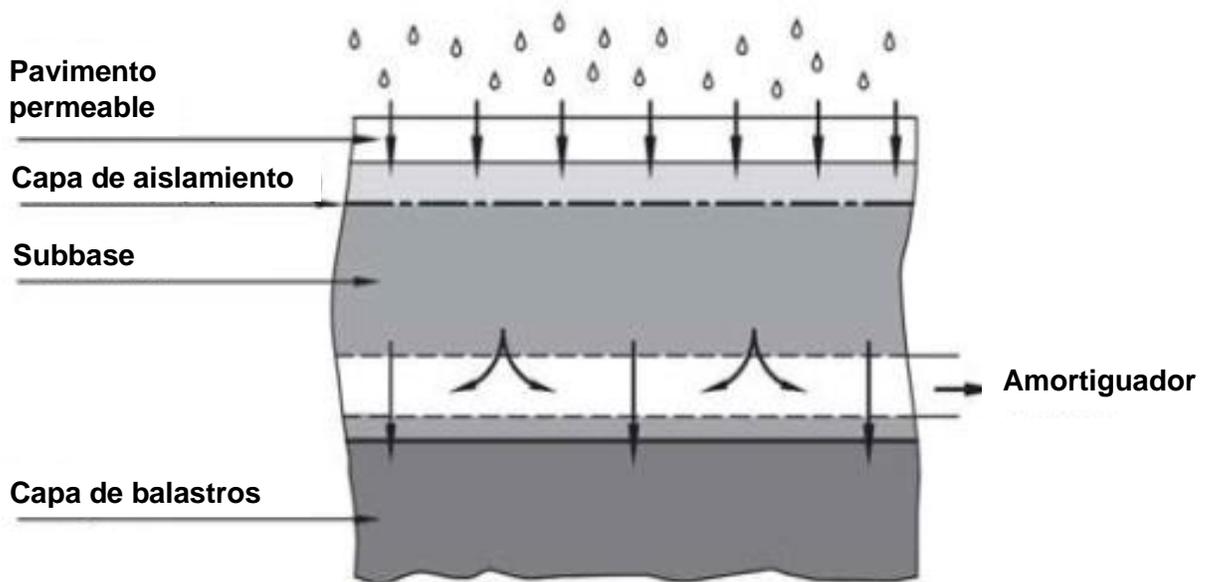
Sección de un pavimento permeable (Xiaoqian, 2020)
